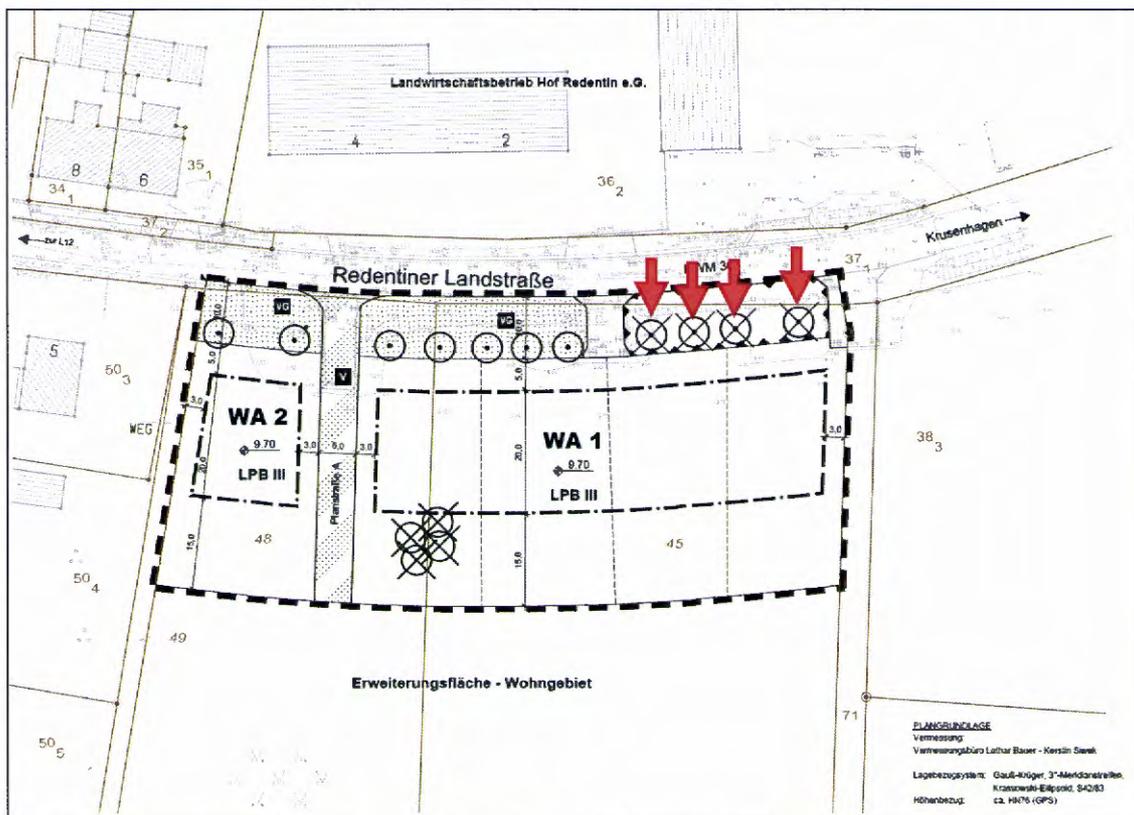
Ausschnitt des B-Plans und Darstellung des Plangebietes. Die im Entwurf vorsorglich noch als Verlust festgesetzten Bäume bleiben infolge der bereits mit einem Fundament vorbereiteten baulichen Ausführung als Schallschutzwand erhalten. Quelle: BAB Wismar 2016.
